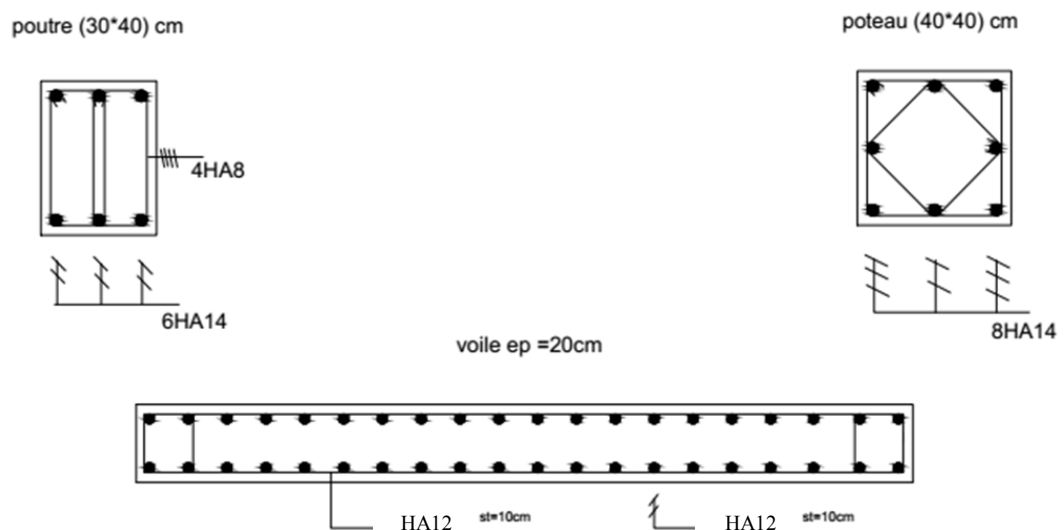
Dimension des sections de béton des poutres et des poteaux et des voiles des deux structures.
